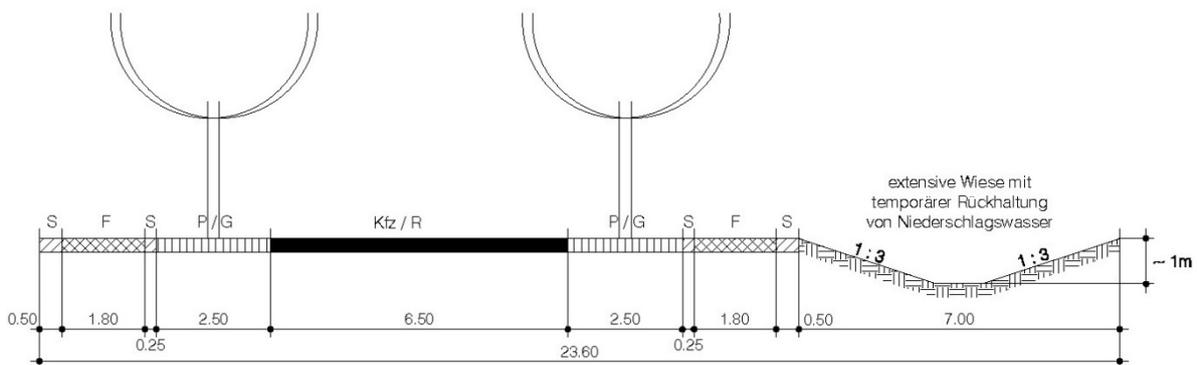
empfohlener Straßenquerschnitt für die Planstraße „C“
